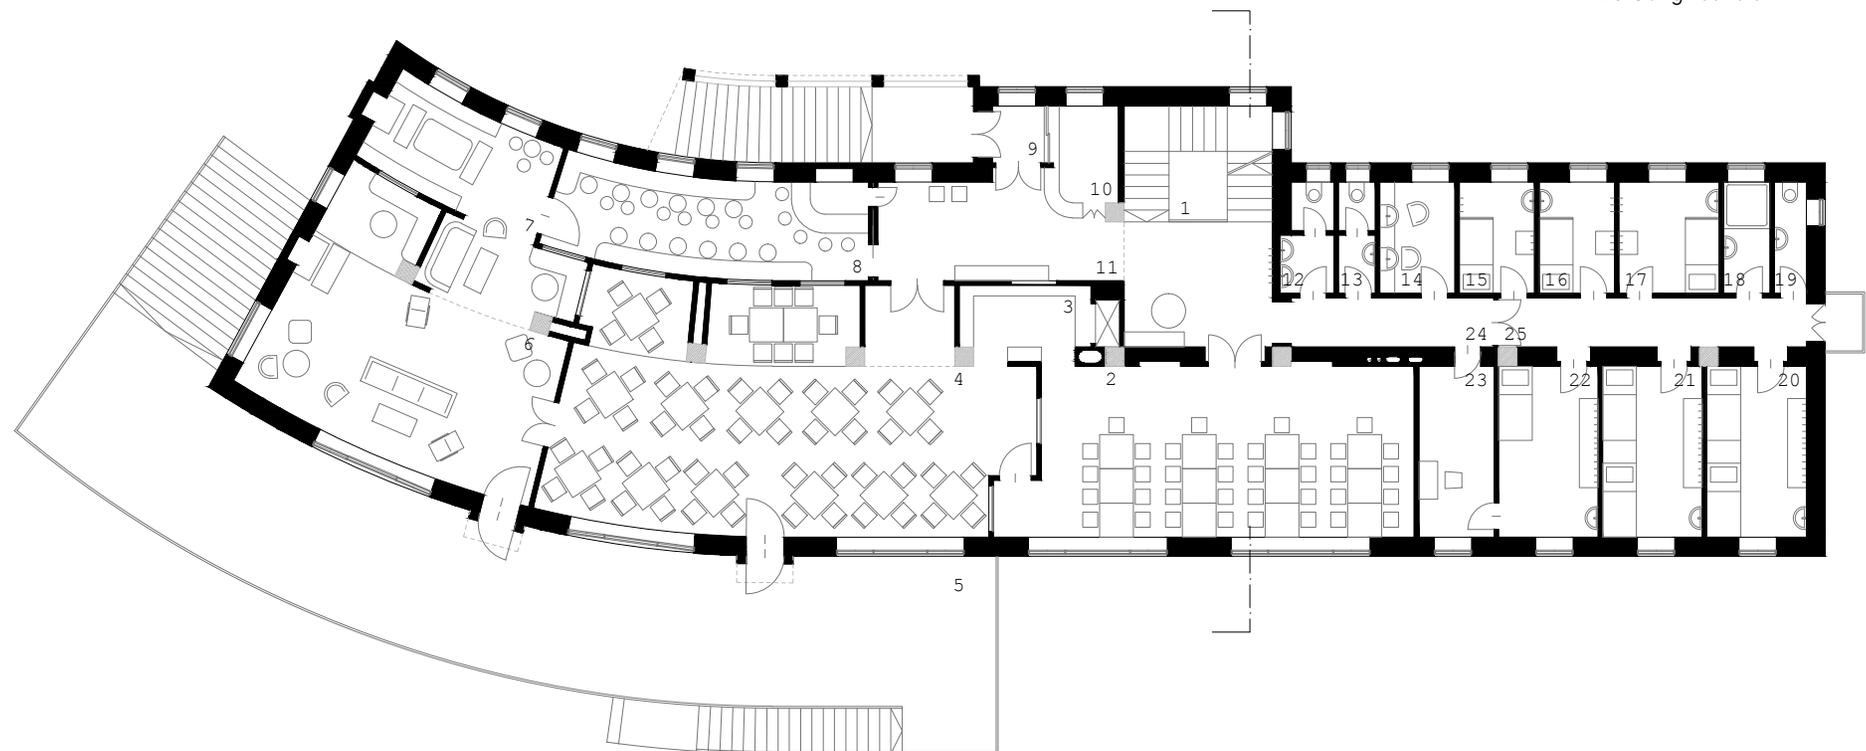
Grundriss Erdgeschoss 1:200
